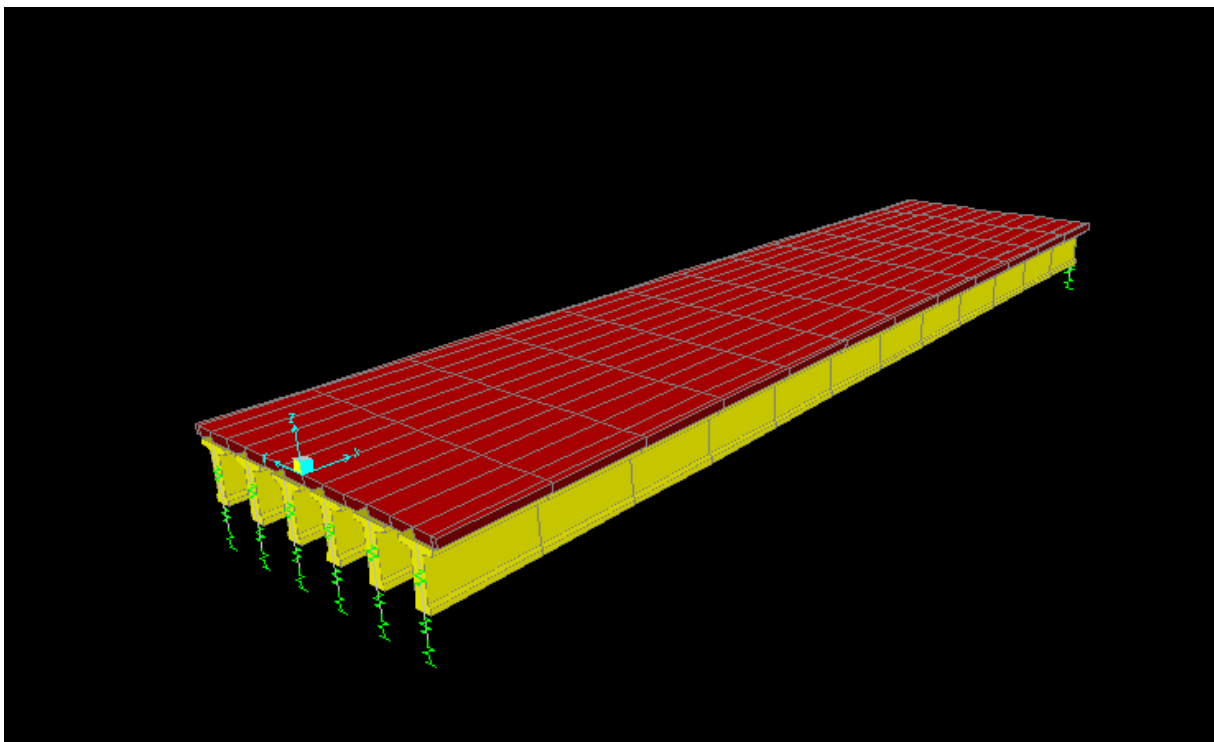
Modélisation de la dalle et de l'entretoise (SAP2000v14)
